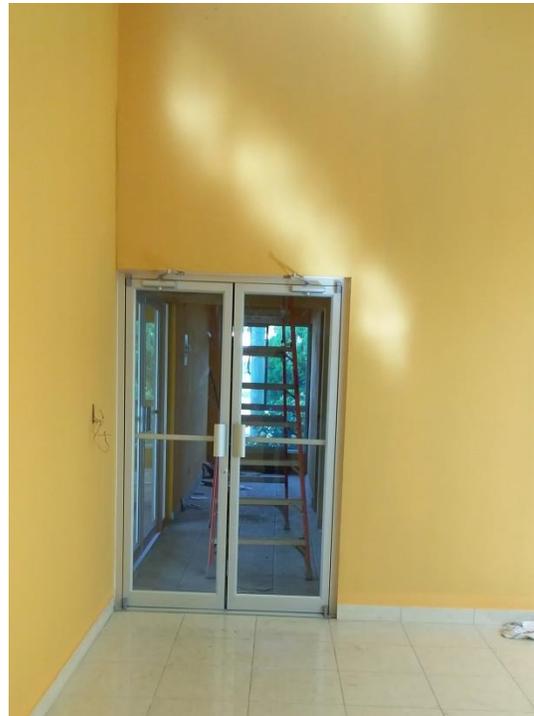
Auditorio, este Color se Aplicó en Pasillos Internos en la Planta Baja, tomada en campo
